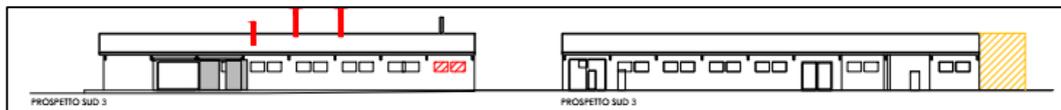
PROSPETTO DELLE MODIFICHE PROPOSTE NEGLI EDIFICI D1 E D2
